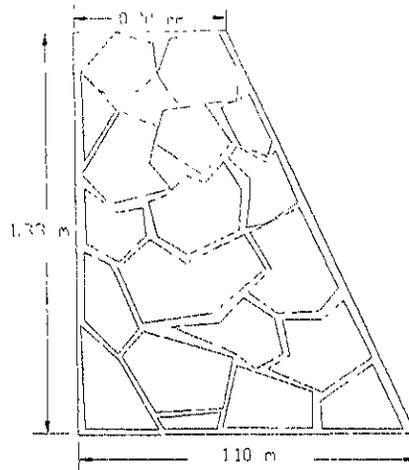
Dimensiones iniciales propuestas de muro de mampostería
